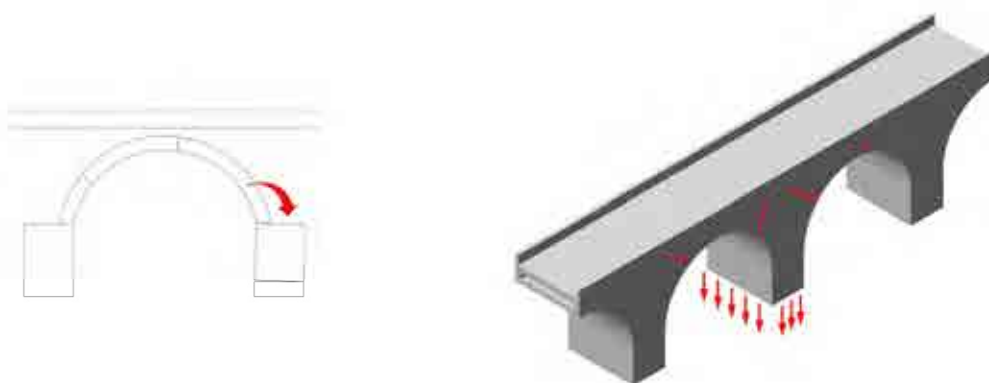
Mecanismos de colapso de los arcos de un puente de fábrica por giro o vuelco de las pilas (Elaboración propia)
